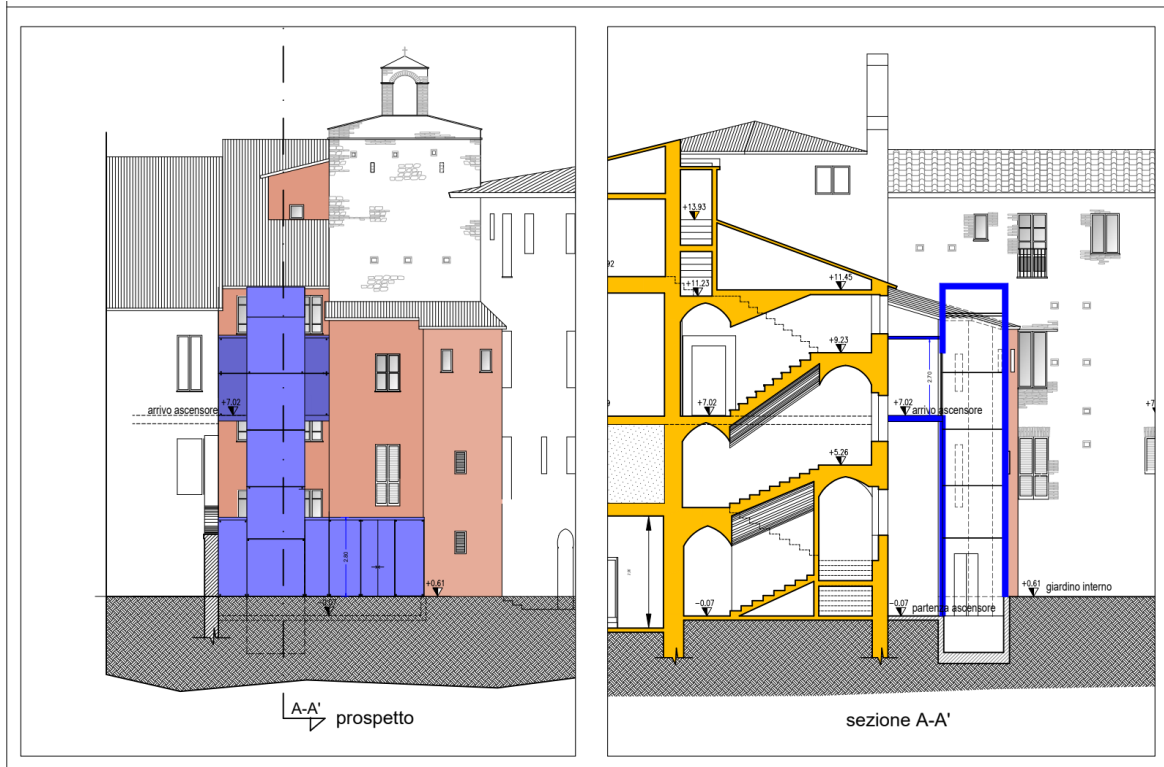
Ipotesi inserimento ascensore, piante e prospetti: soluzione 2
